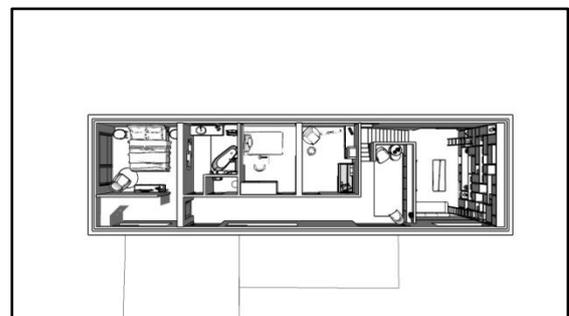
Plan en perspective du R+1 de la maquette 2 en SketchUp
